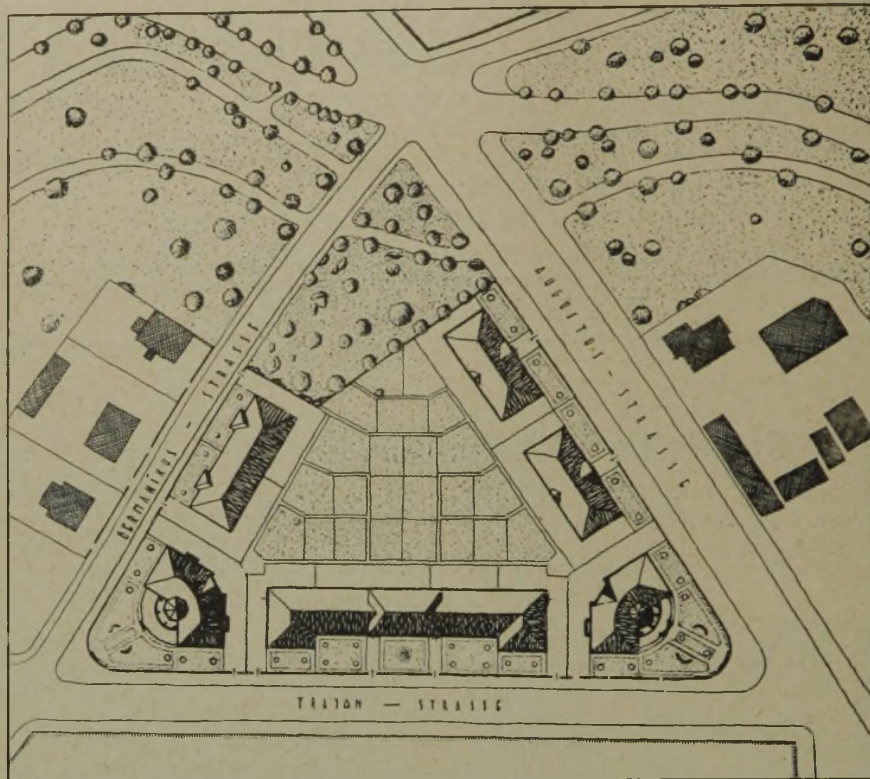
Lageplan der städtischen Wohnbauten auf Baublock 84. (1 : 1600)
